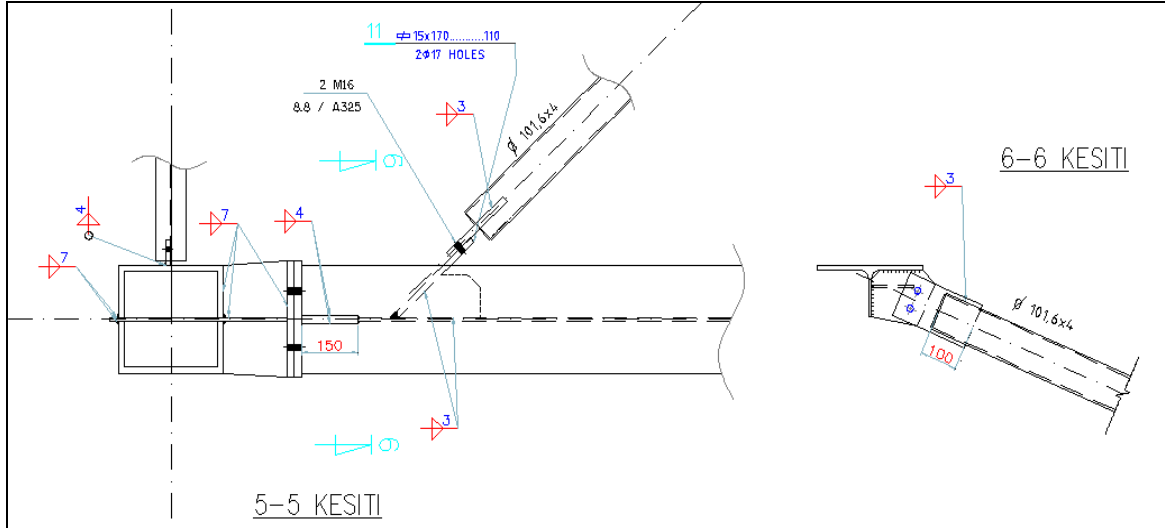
Kolon ayağı bağlantısı detayı.
